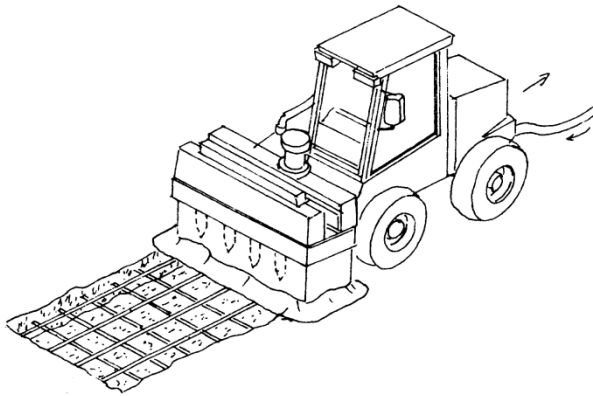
Máquina de hidrodemolição para pavimentos [Mascarenhas, 2008].
